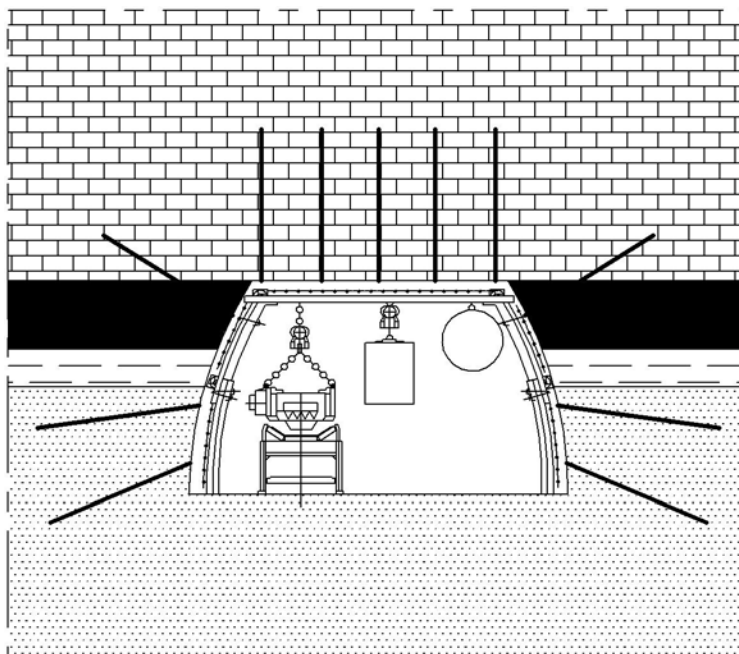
Поперечное сечение уклона (ходка) пласта k_8 в проходке.
